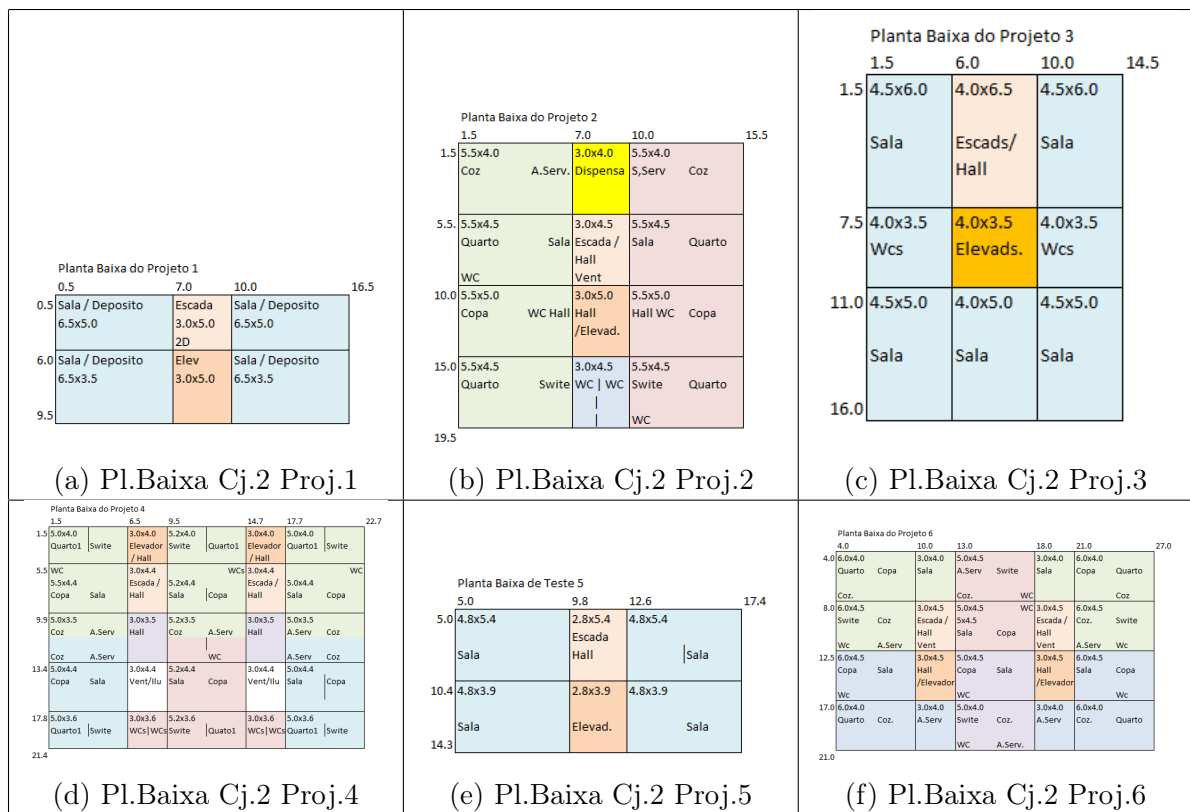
Plantas Baixas - Cj.2 - Pjs.Treino 1 a 4 - Teste 6
